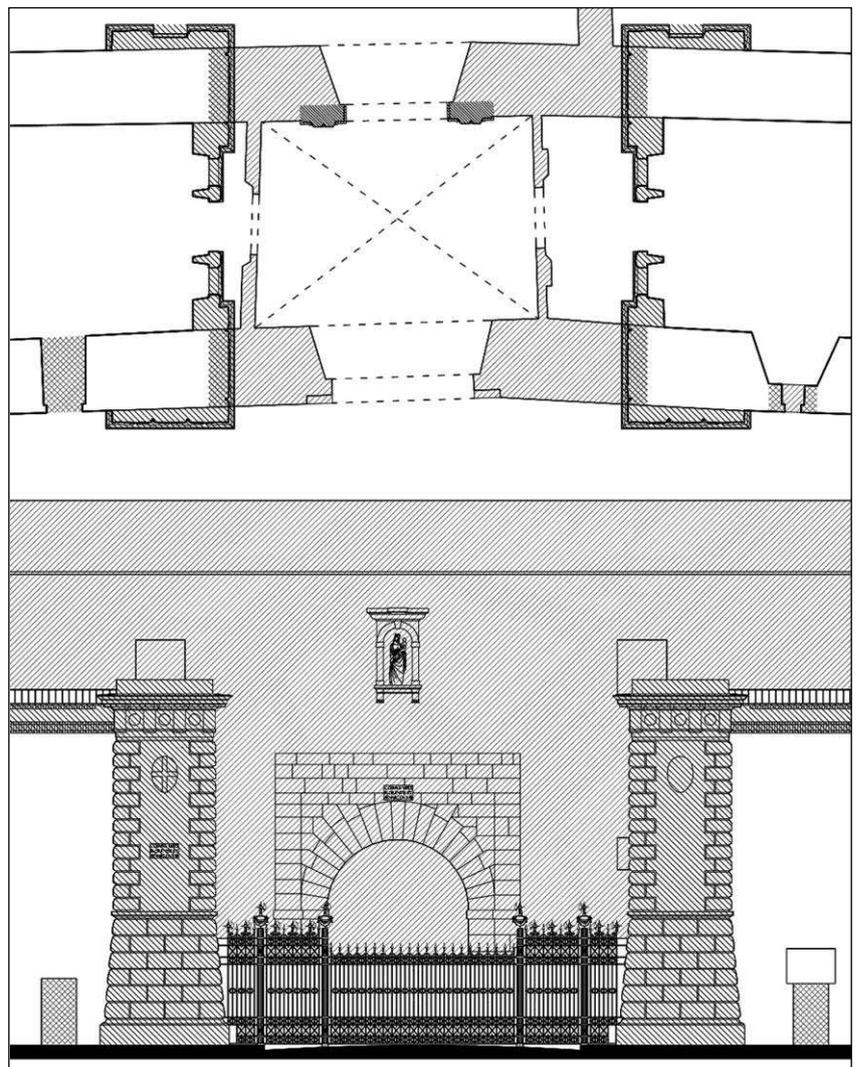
Pianta e prospetto della porta e della barriera con sovrapposti lo stato pre- e post-demolizioni (Elaborazione dell'autore).
